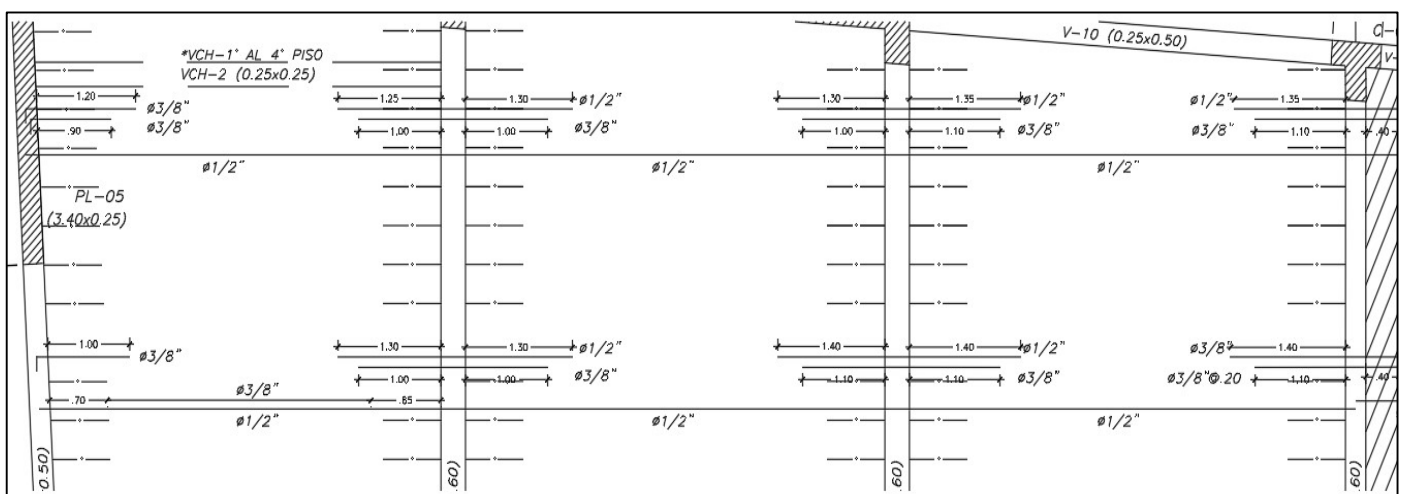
Diseño final de las viguetas tipo 1 y tipo 2
